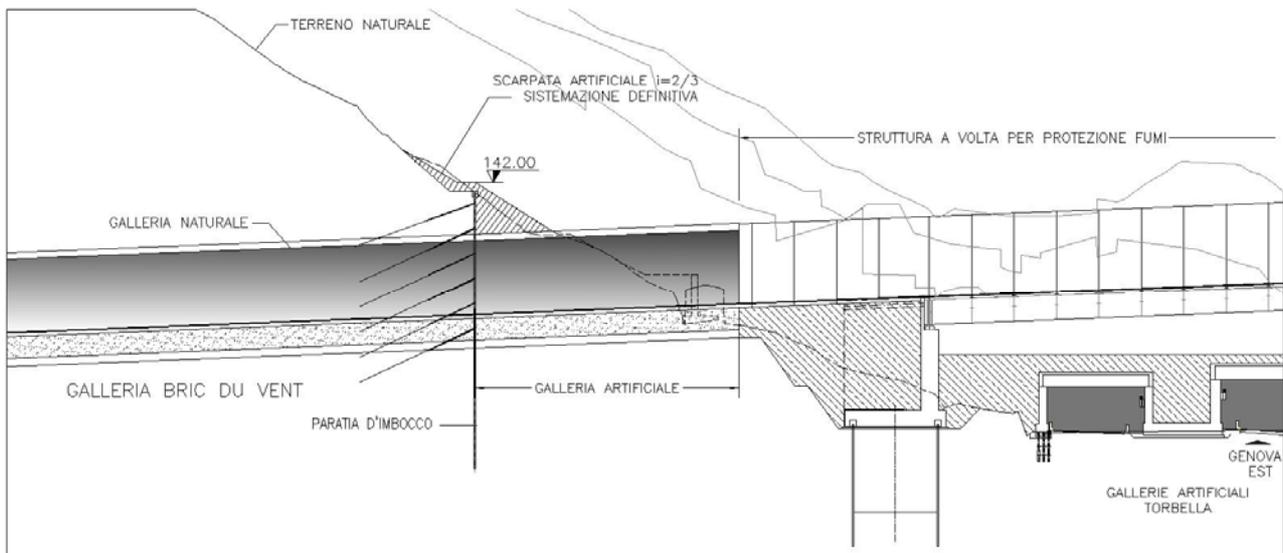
Profilo longitudinale della galleria Bric du Vento lato Livorno (cfr. AUA0161-2)
